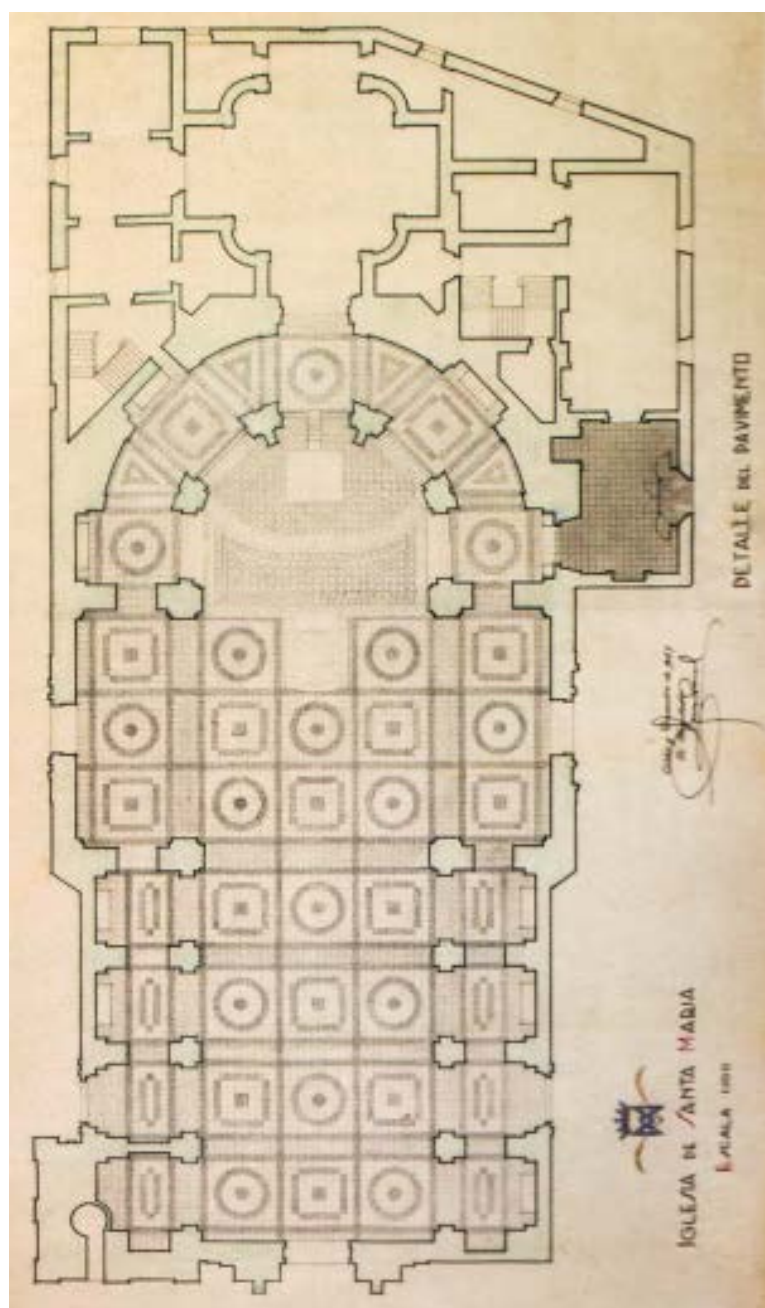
Plano de pavimento. Proyecto de Restauración de la Iglesia de Santa María de Elche de Antonio Serrano en 1940 (Ajuntament d'Elx, 2010).
